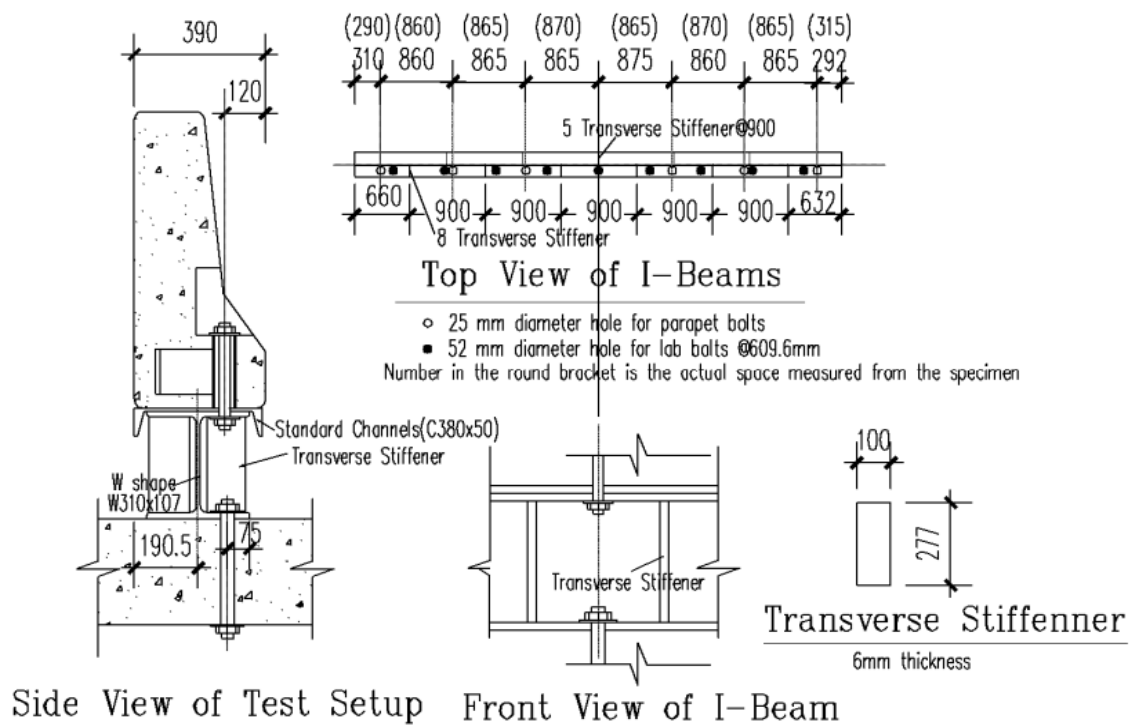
Ancrage par boulons (Ngan, Août 2008)
